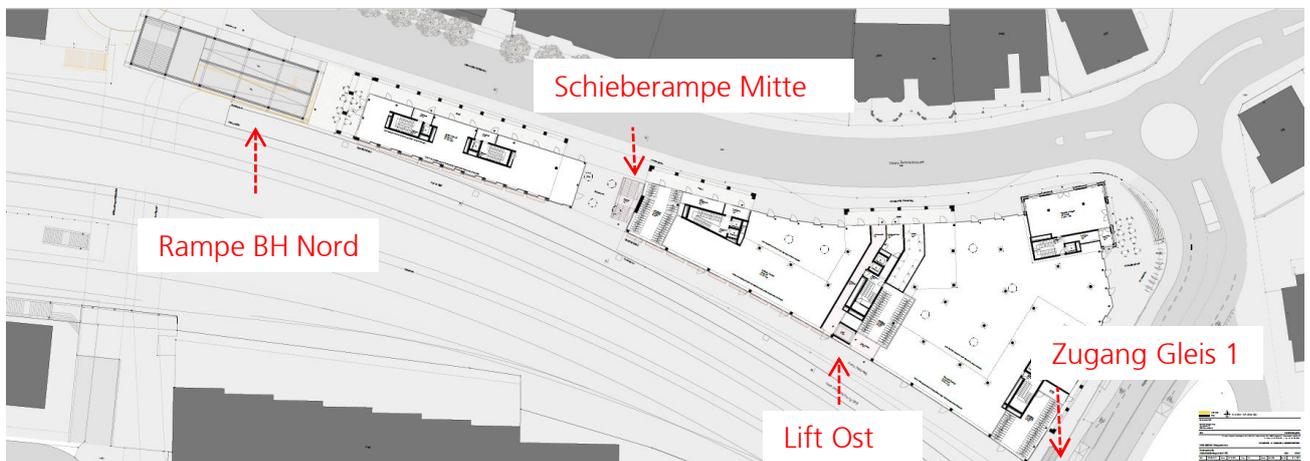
Gestaltungsplan Untere Bahnhofstrasse 1 - 11, Erdgeschoss
